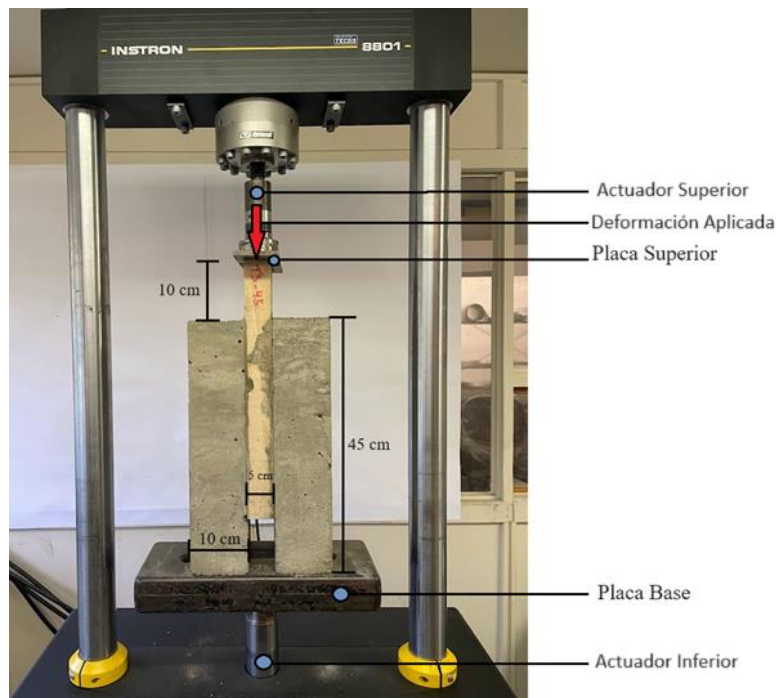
Espécimen instalado en máquina de prueba de corte.
